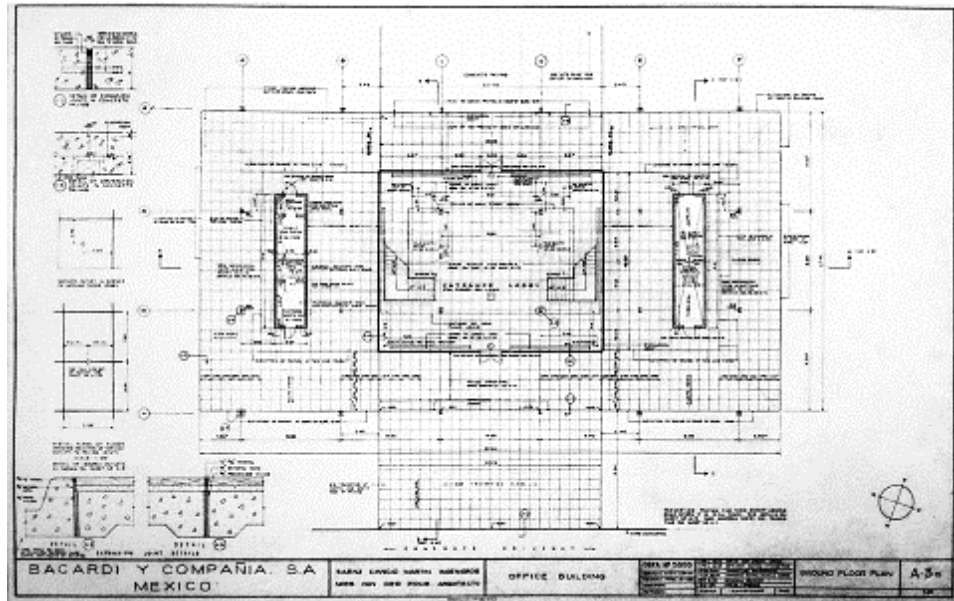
Planta baja Edificio de Oficinas Bacardí Mx. Interior
